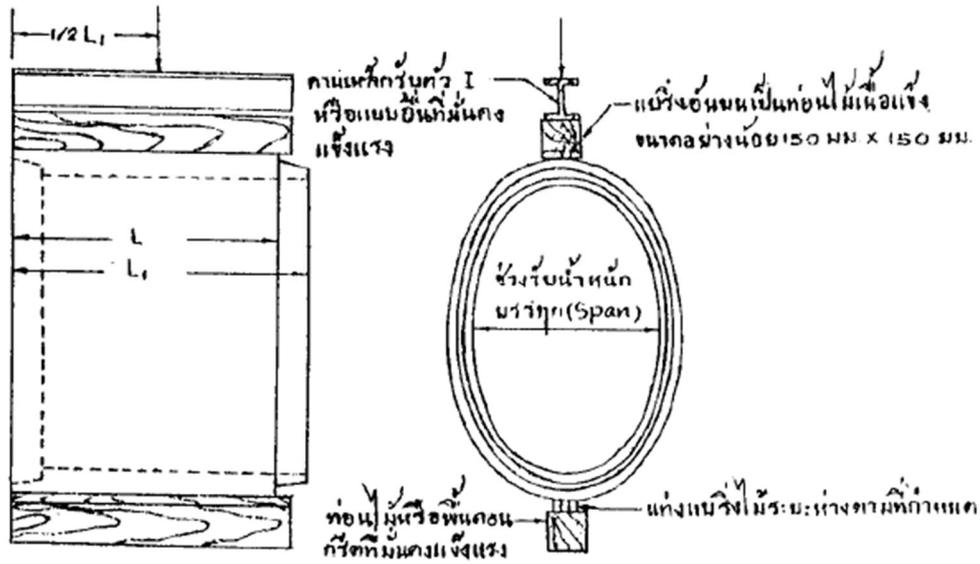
การทดลองท่อแบบปากลิ้นรางโดยวิธี THREE-EDGE BEARINGS
